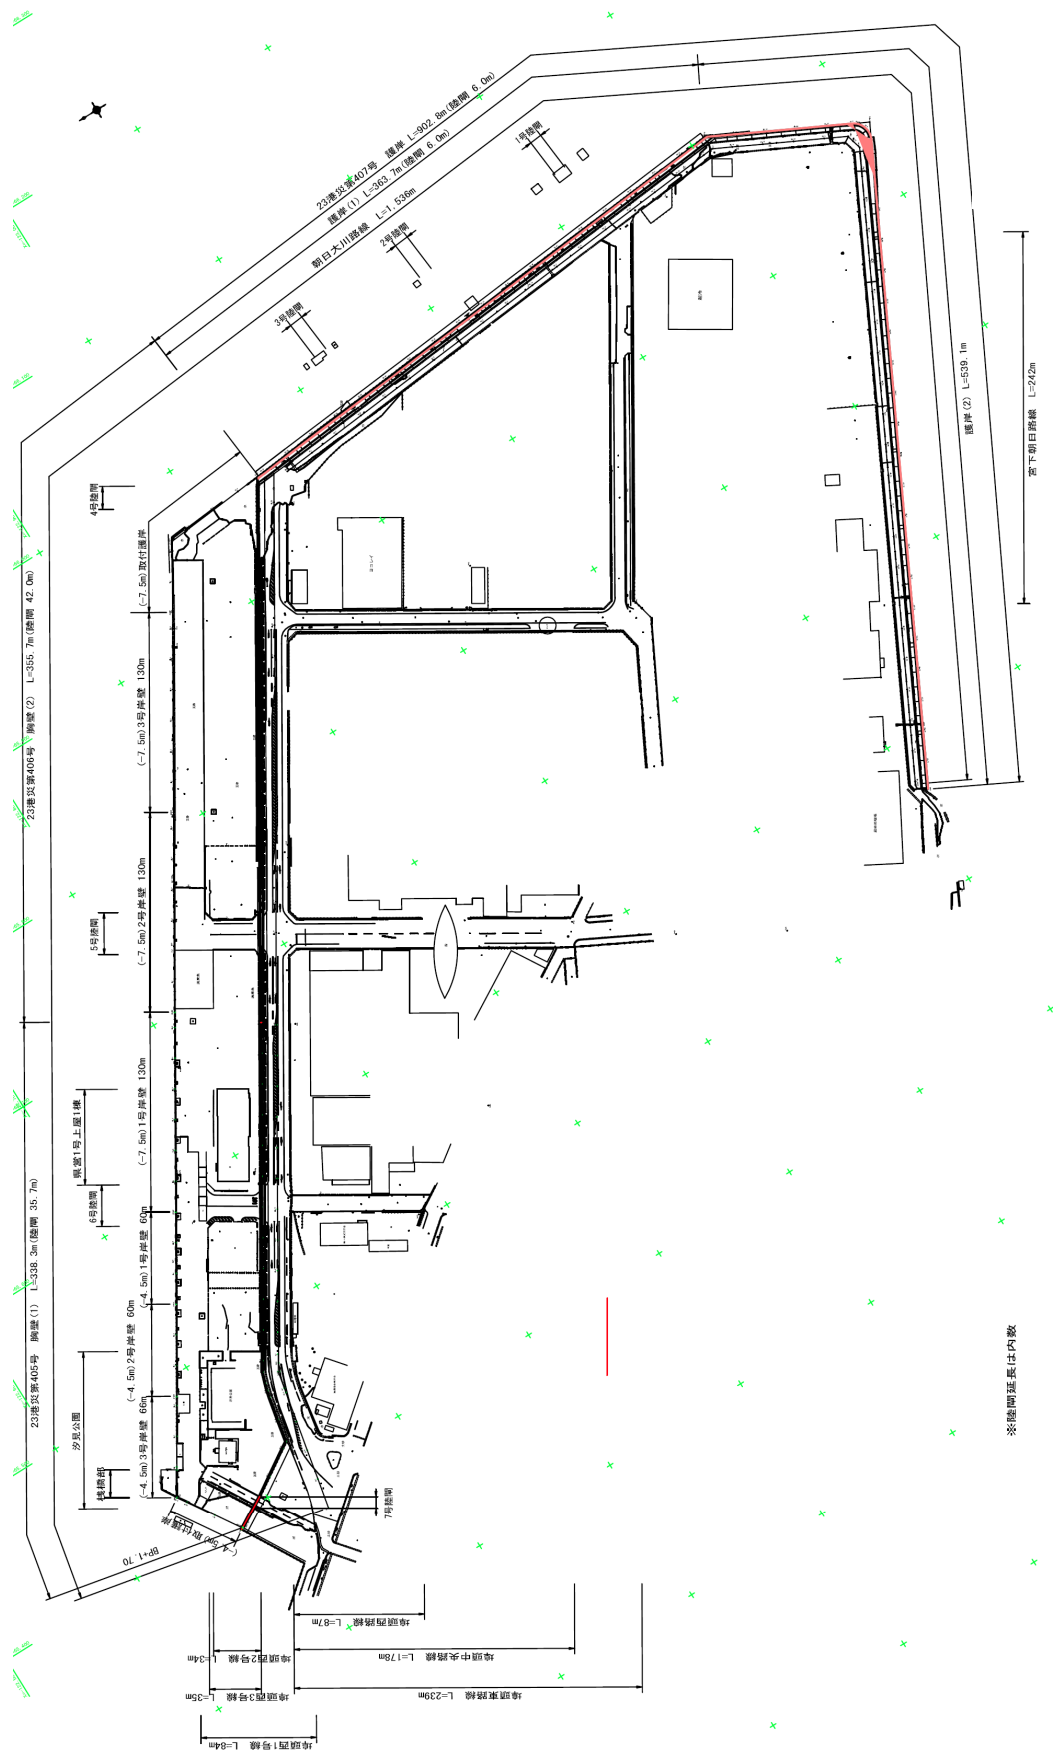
No.1 朝日地区_胸壁の平面図(復旧後)
